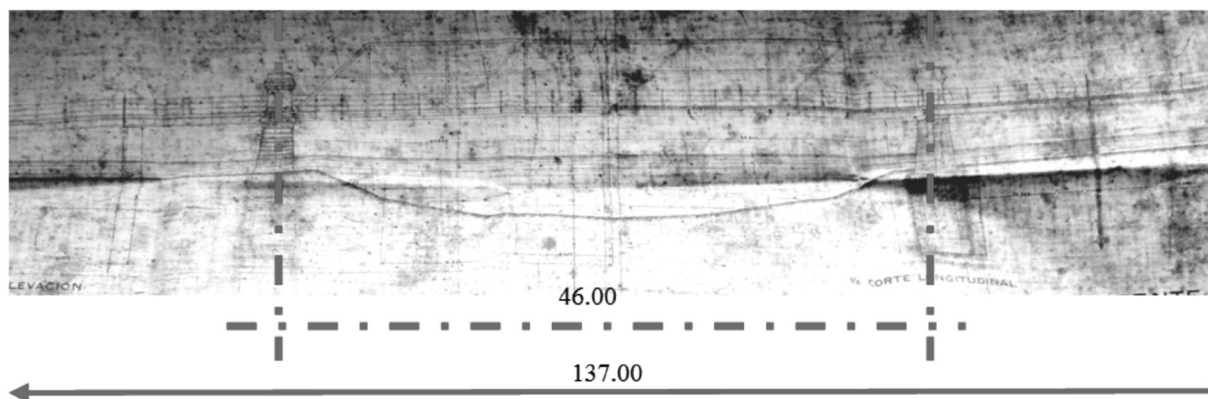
Corte longitudinal de fundaciones. Fuente: Dirección de Hidráulica Sección Dolores.
